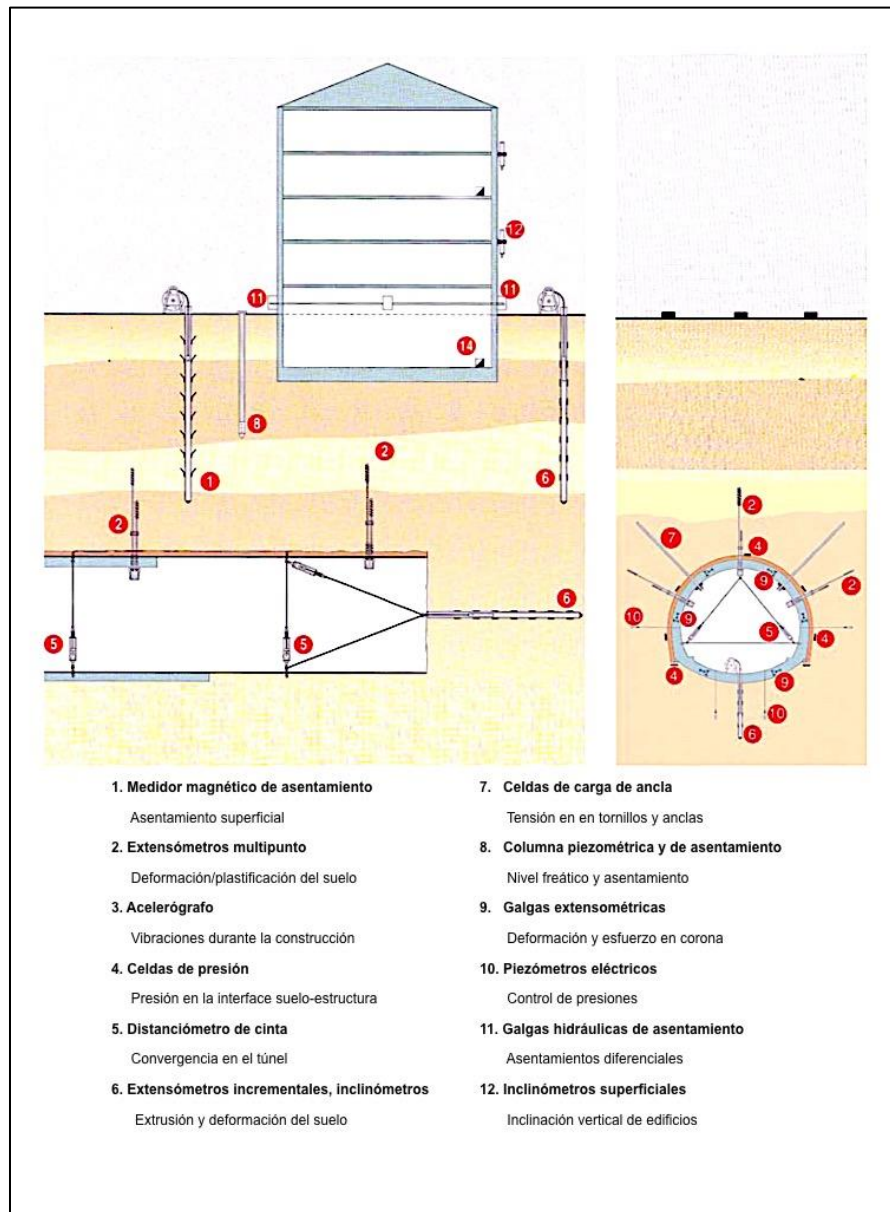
Instrumentación sugerida para el monitoreo durante construcción y operación de túneles. Obtenido de Lunardi (2008).
